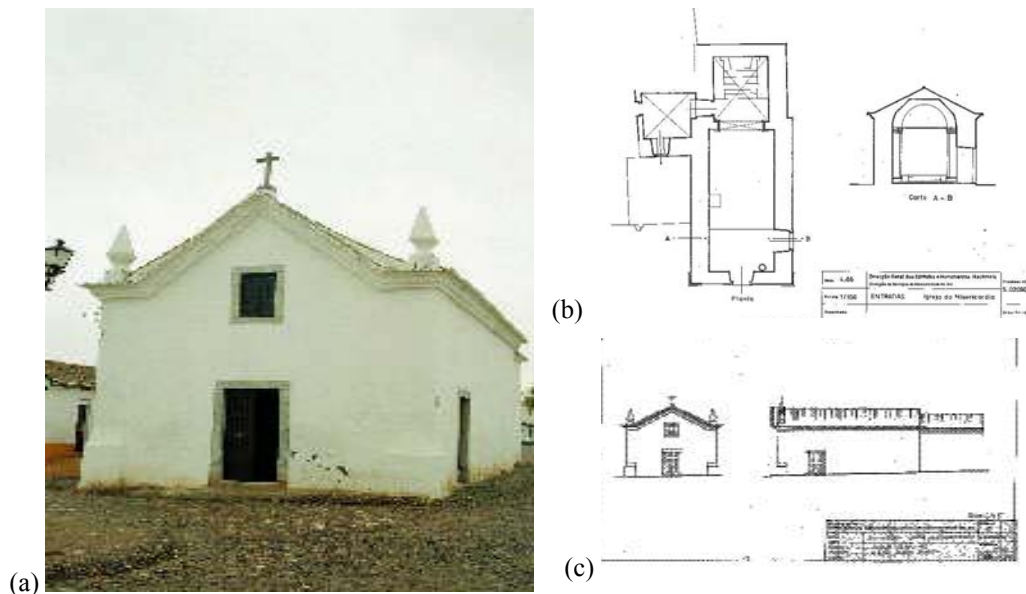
Peças desenhadas [DGEMN]: (a) fotografia da fachada; (b) planta e corte transversal; (c) alçados.
